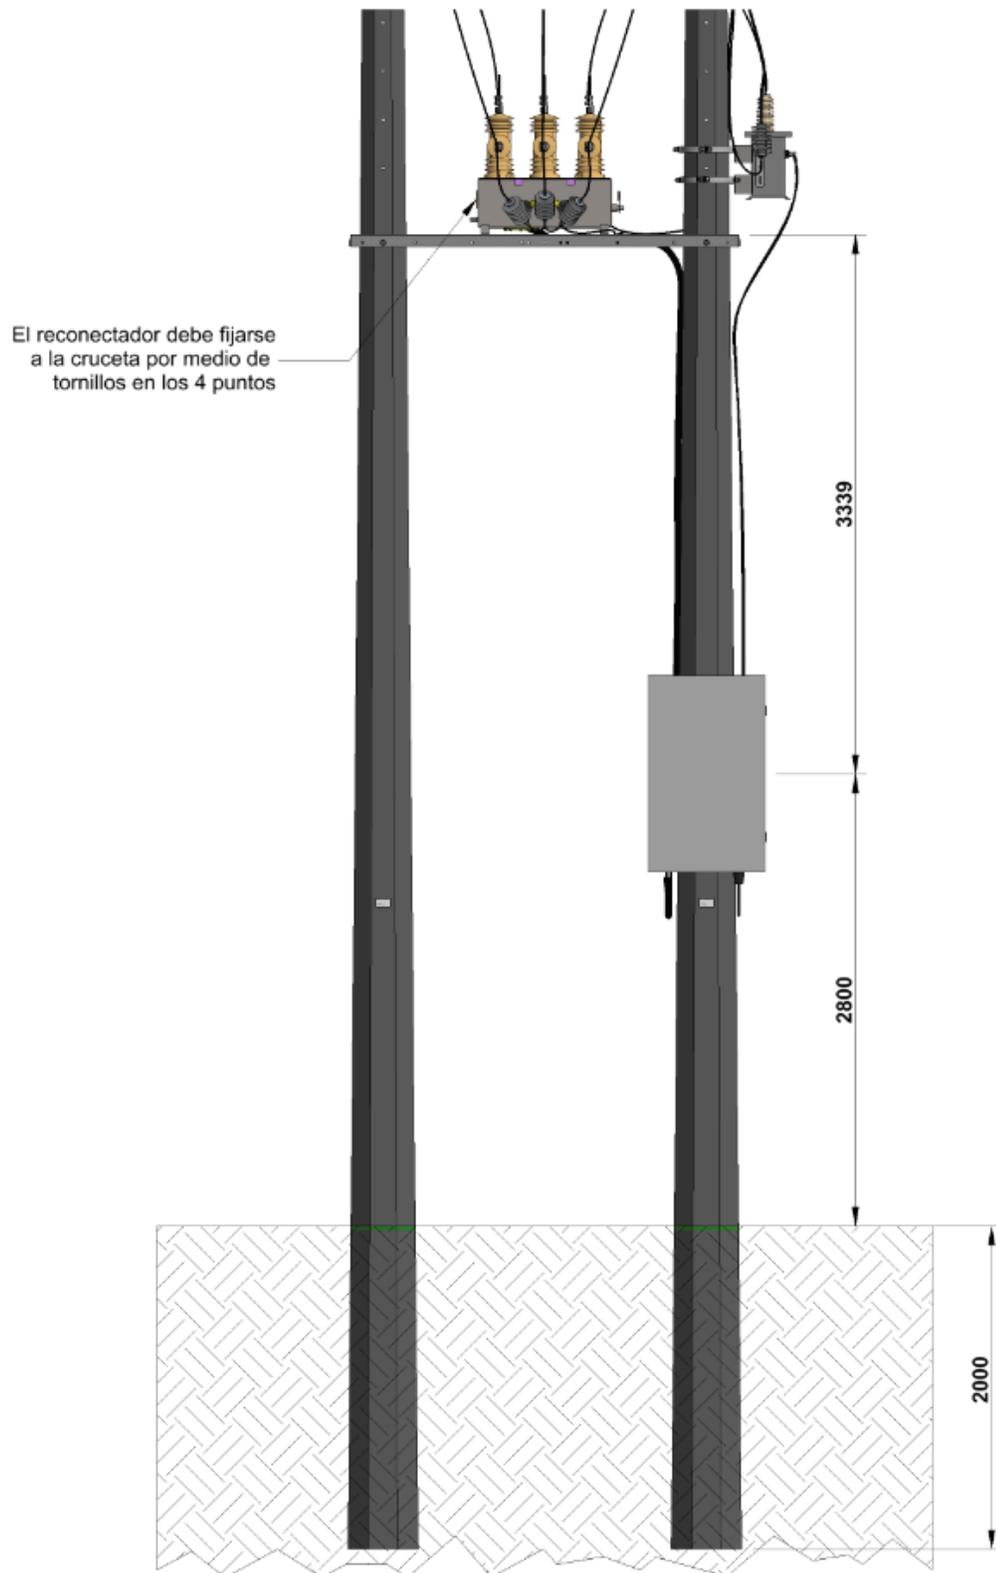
Detalle montaje Bypass y Seccionamiento - Instalación de reconector trifásico 13.2 kV en estructura tipo H
